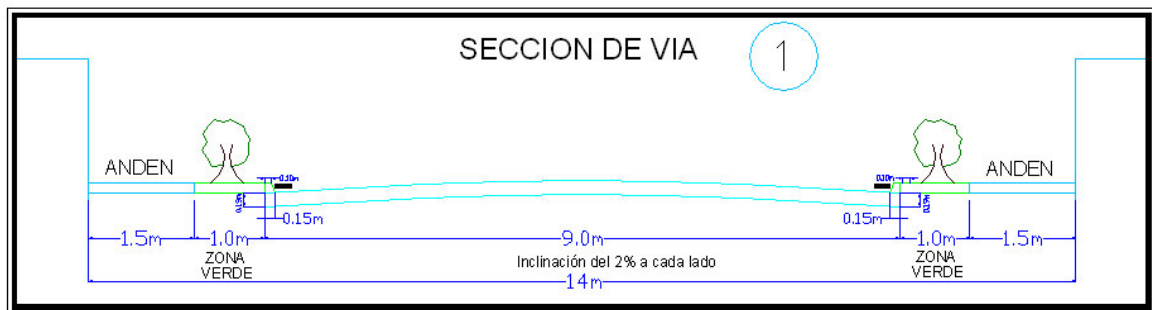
Corte transversal de la Calle 21A - Villa Flor 1
